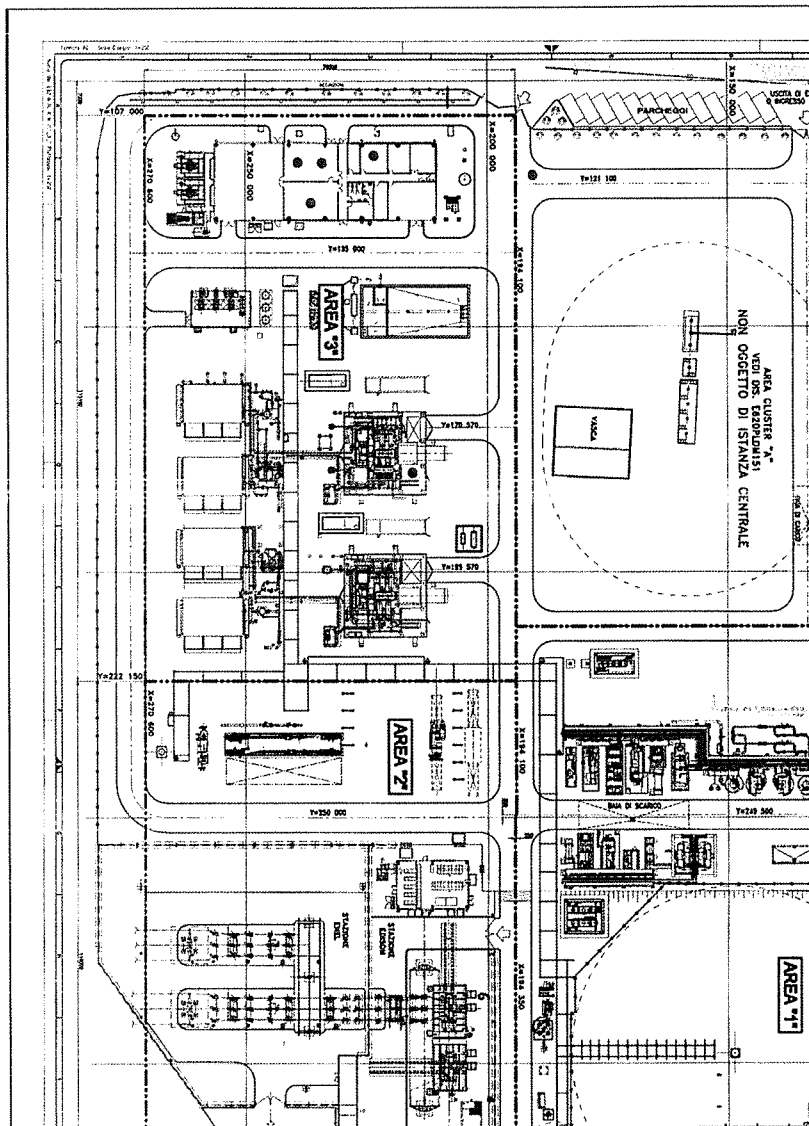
planimetria della centrale di stoccaggio sita in località San Potito (RA)
